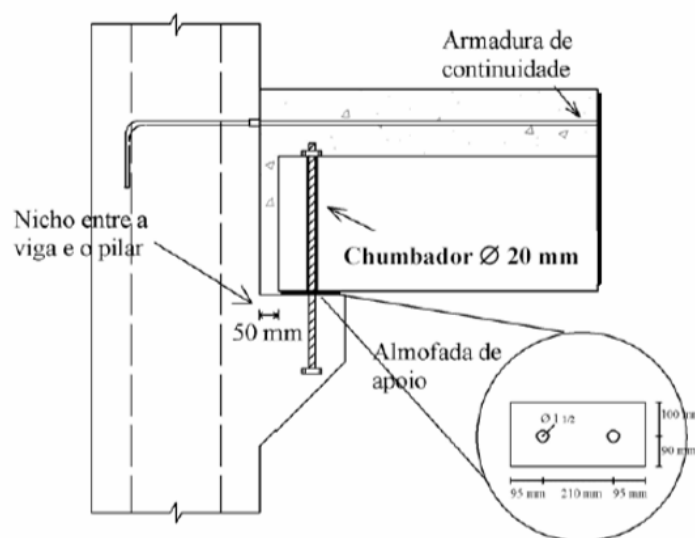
Detalhe ligação viga x pilar com pino conector e neoprene
